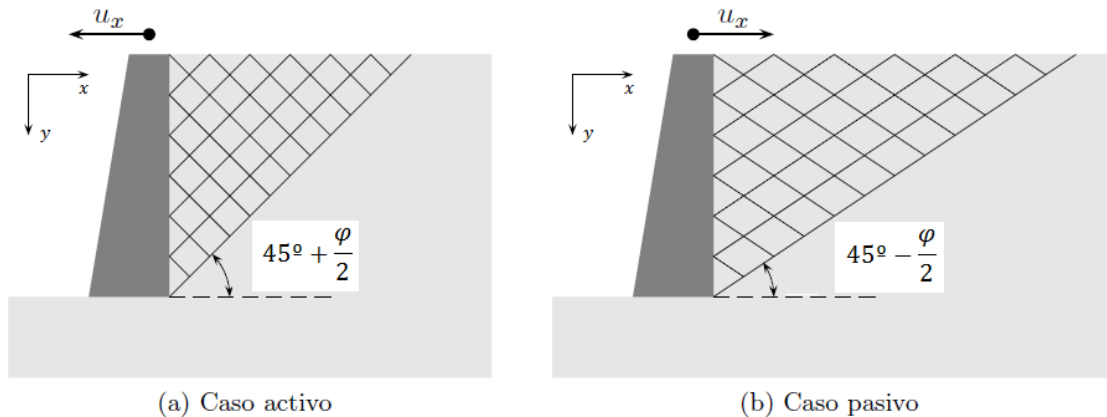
Inclinación planos de falla caso activo y pasivo. Adaptada Saez (2010).
